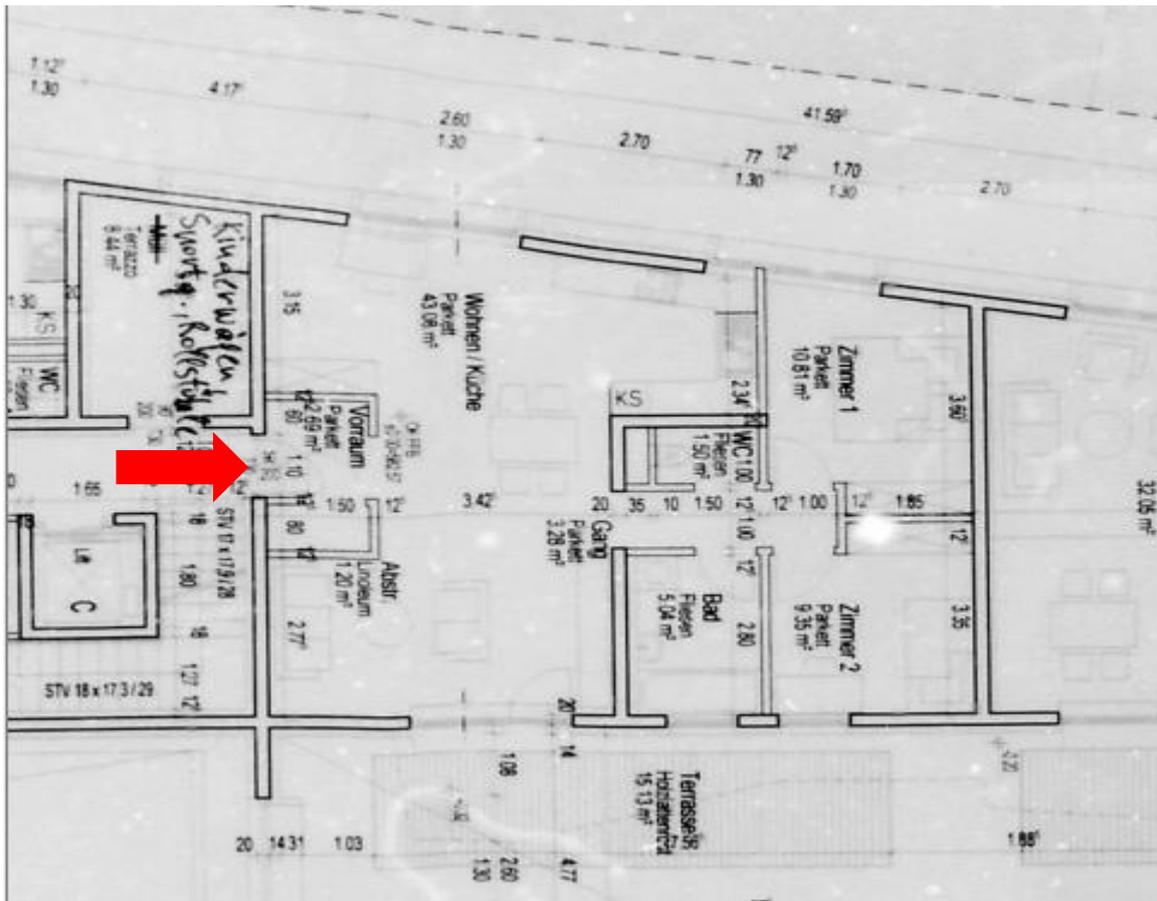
Grundriss Wohnung aus Einreichplanung
